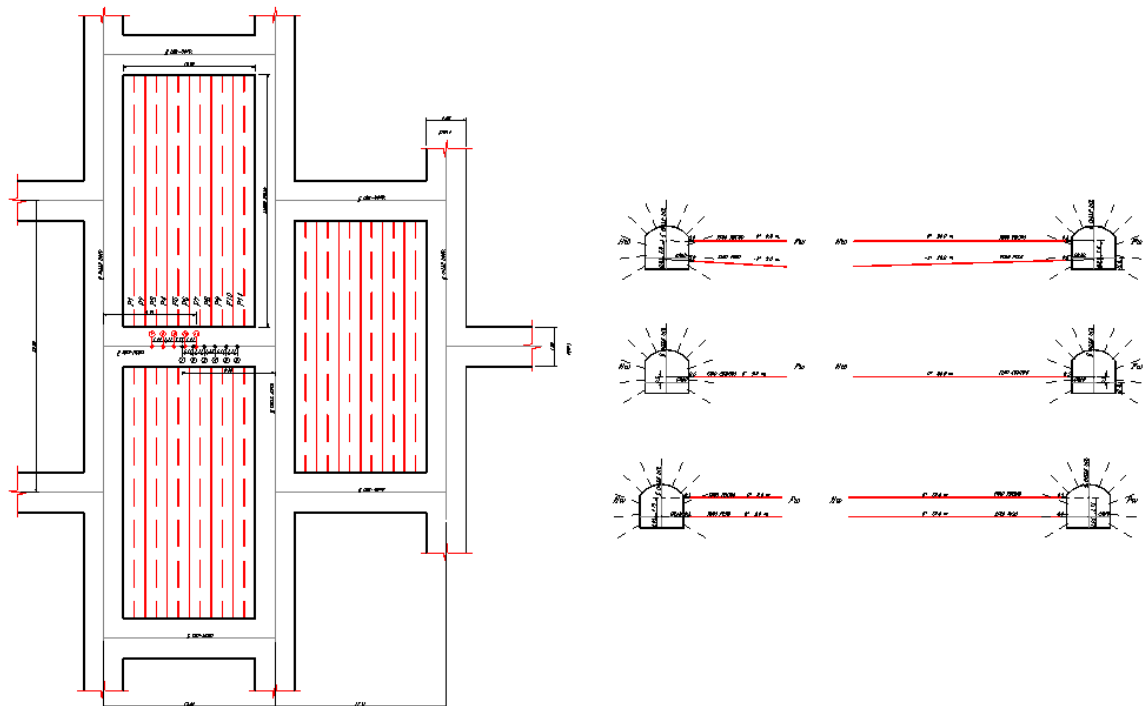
Corte plano mediante conexiones y tiros paralelos, Diablo Regimiento (Undercutting workshop, 2008)
